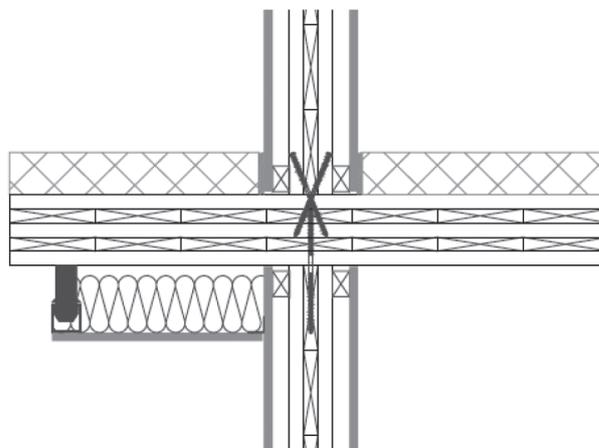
Appui entre panneaux de mur et de plancher assemblé par vissage
